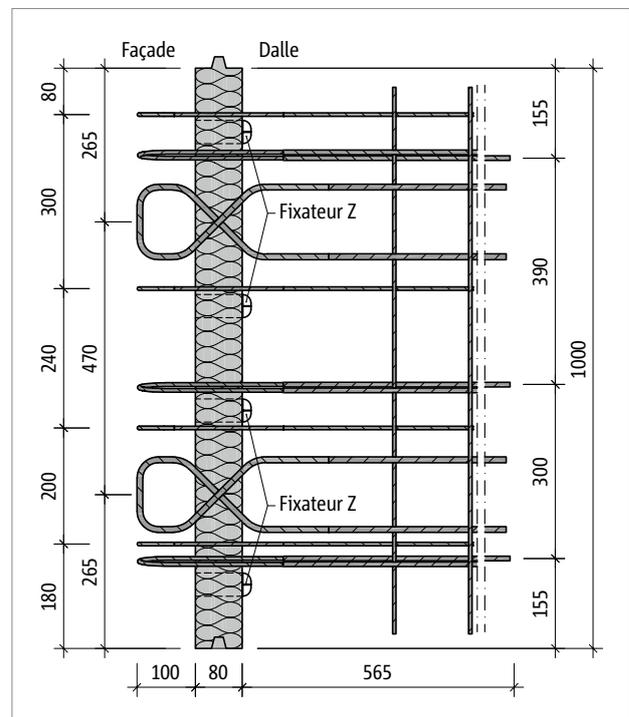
Schöck Rutherma® T type DFi-S-V3-LR100 H160 à H190 : vue en plan du produit
